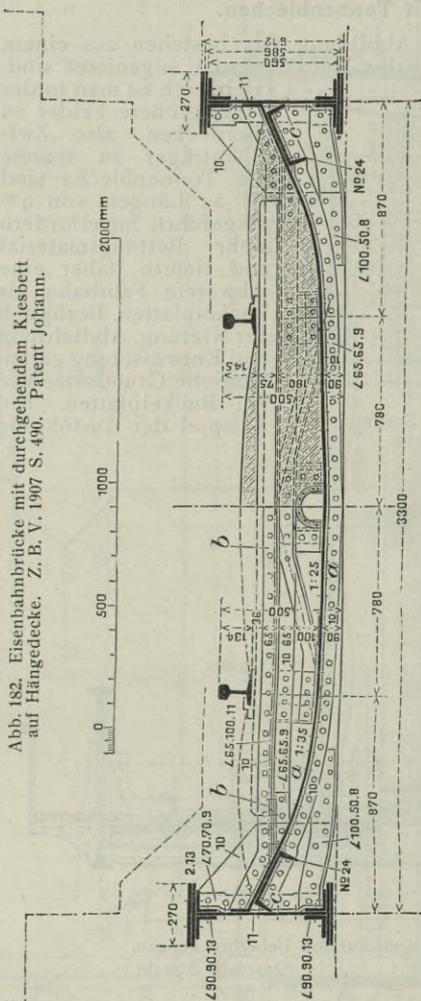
Eisenbahnbrücke mit durchgehendem Kiesbett auf Hängendecke, Z. B. V. 1907 S. 490. Patent Johann.
